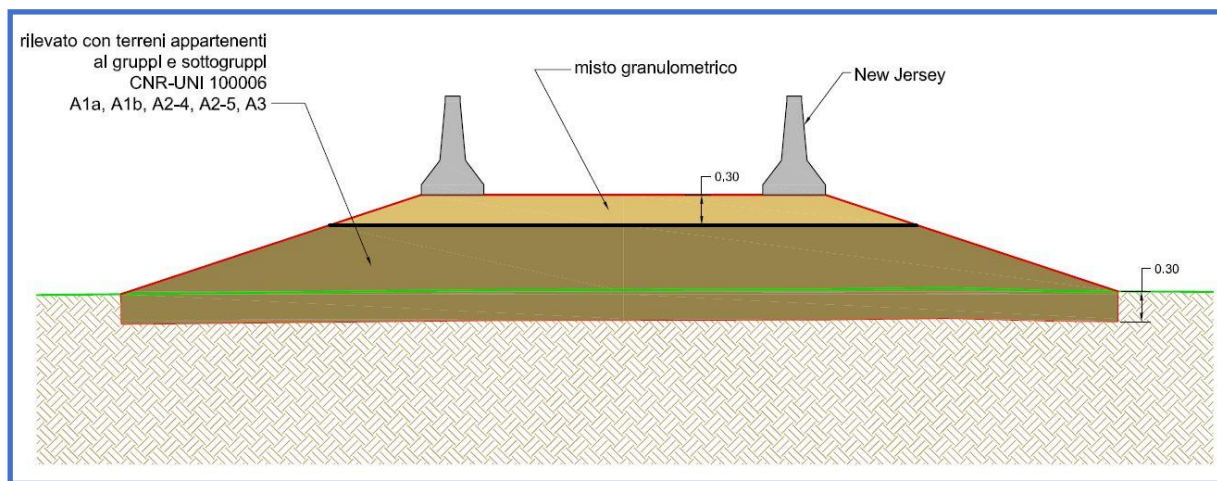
Zona intervento 4 – Sezione tipo della pista provvisoria
